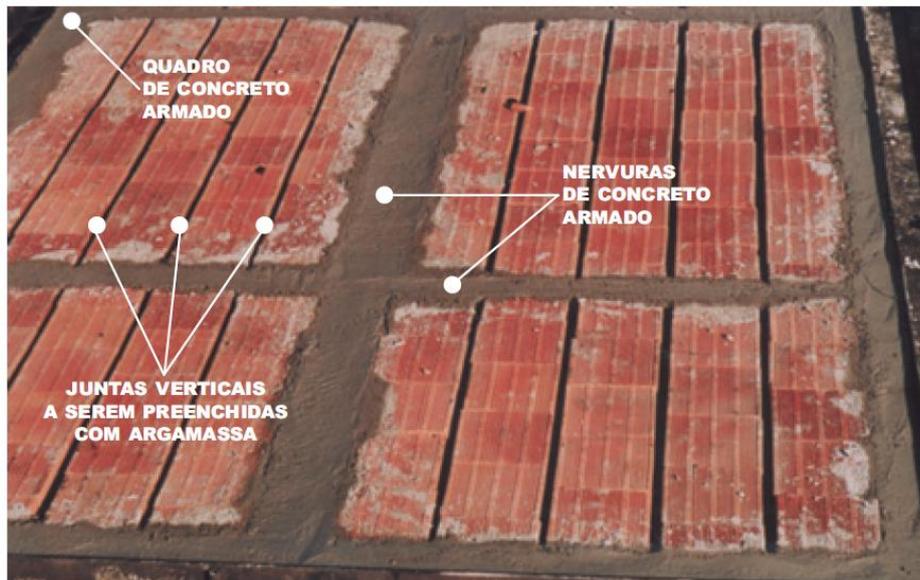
Vista ilustrativa do painel de paredes JET CASA, sem o revestimento de argamassa
